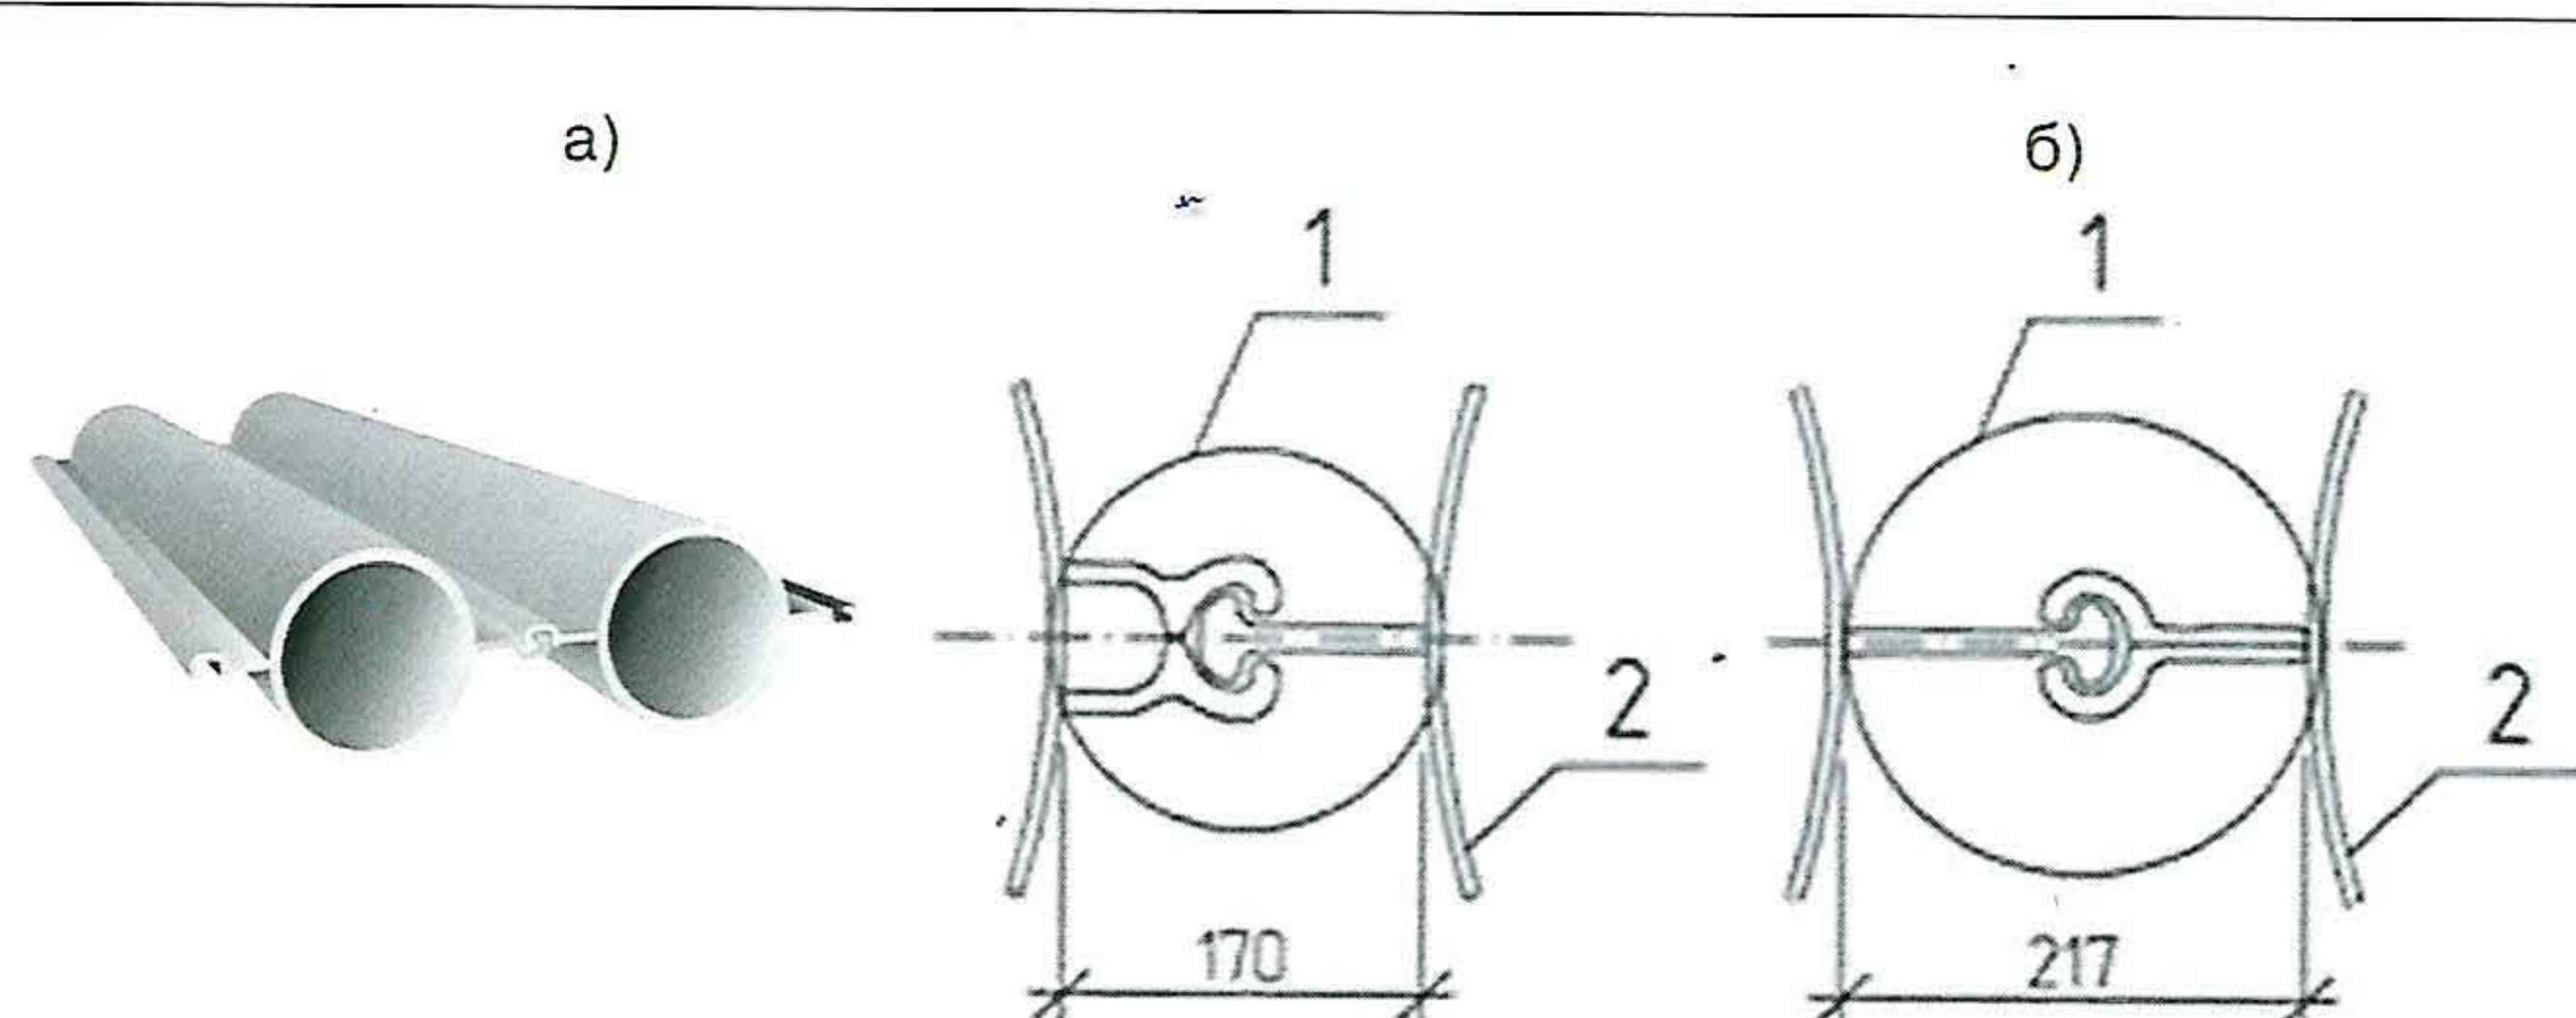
Конструкции трубчатого сварного шпунта: а) схема элементов ШТС; б) 1 – высокоэффективные замковые соединения, разработанные ООО «Трест Запсибгидрострой», 2 – стенка трубы
